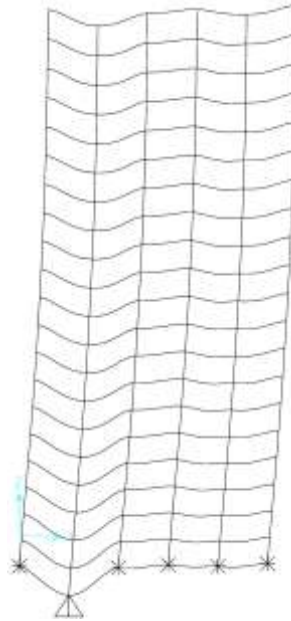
Deformadas – Corte Transversal passando pela Viga V12 – Caso 3 – Com o vento
